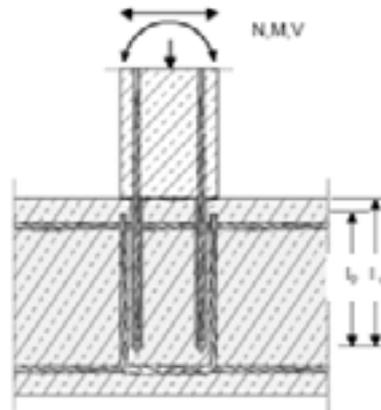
giunzione per sovrapposizione di pilastri sollecitati a flessione o muri a fondazioni.
